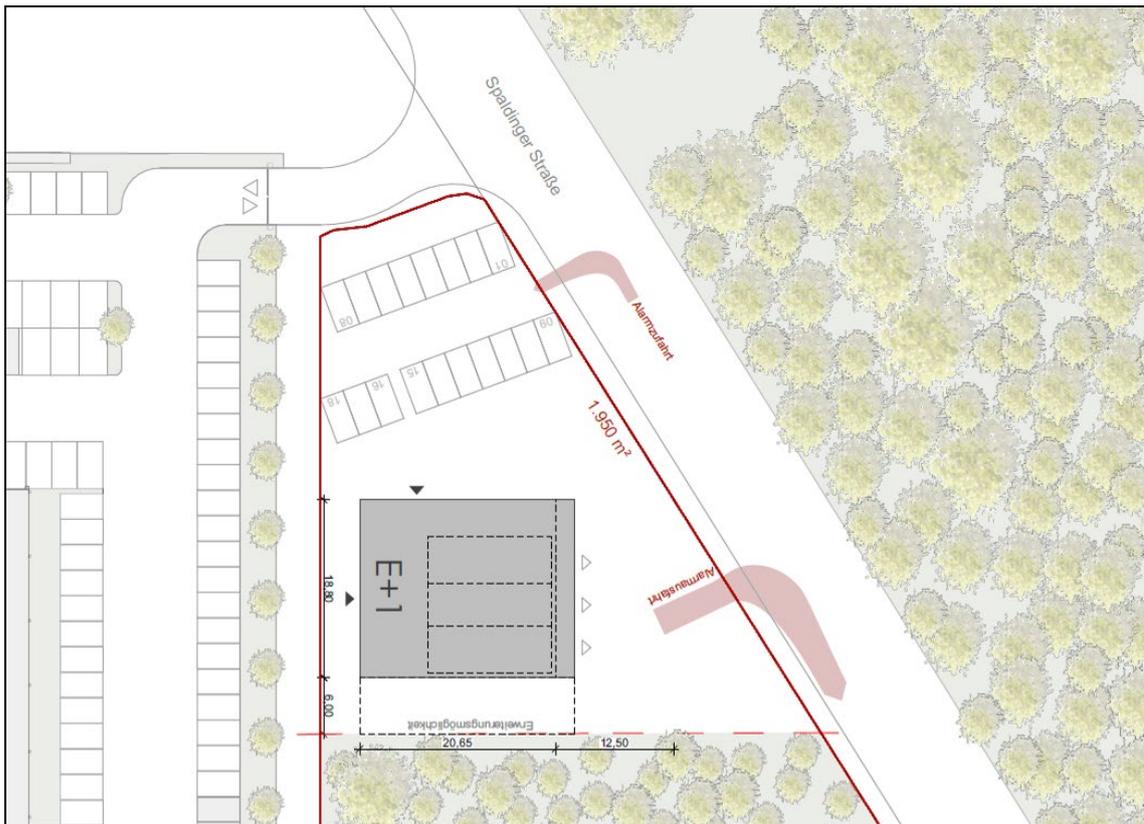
Vorplanung des Architekturbüros, Quelle: Architekturbüro kplanAG Abensberg, Lageplan vom 03.03.2020
